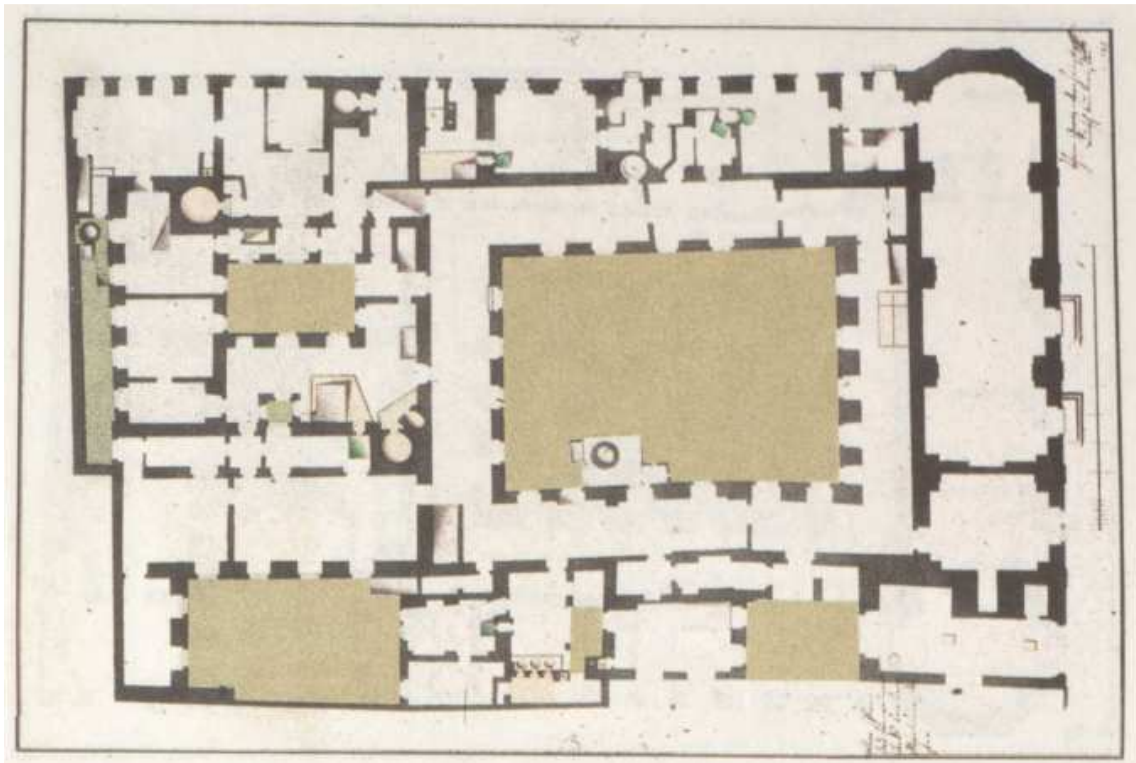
Klosterkomplex in der Singerstraße, Grundriss, Johann Georg Kornhäusel, 1782
